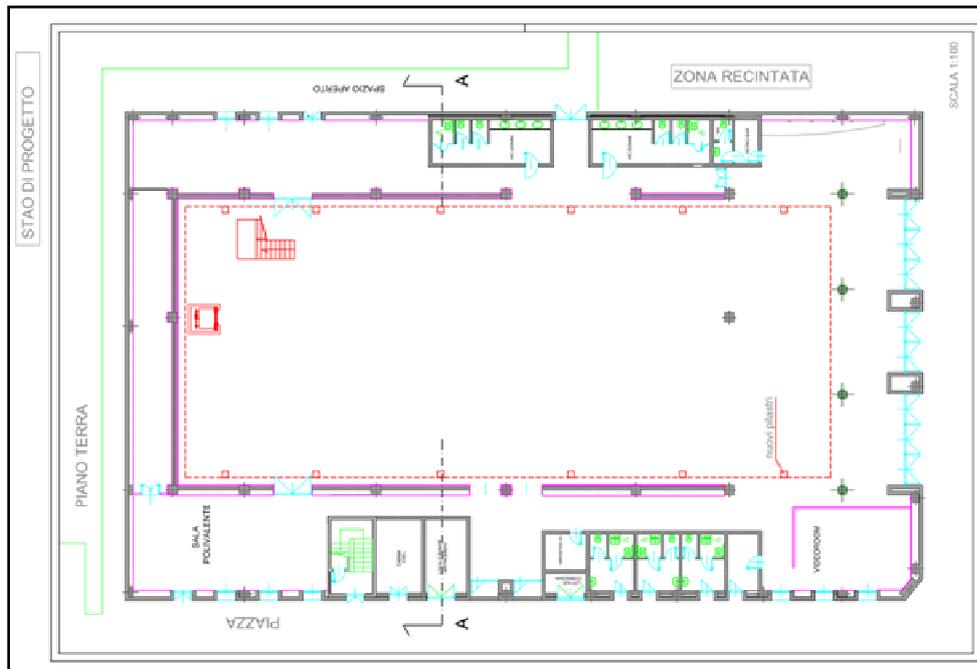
Stato di Progetto: Pianta - Indicazione del nuovo solaio in rosso
